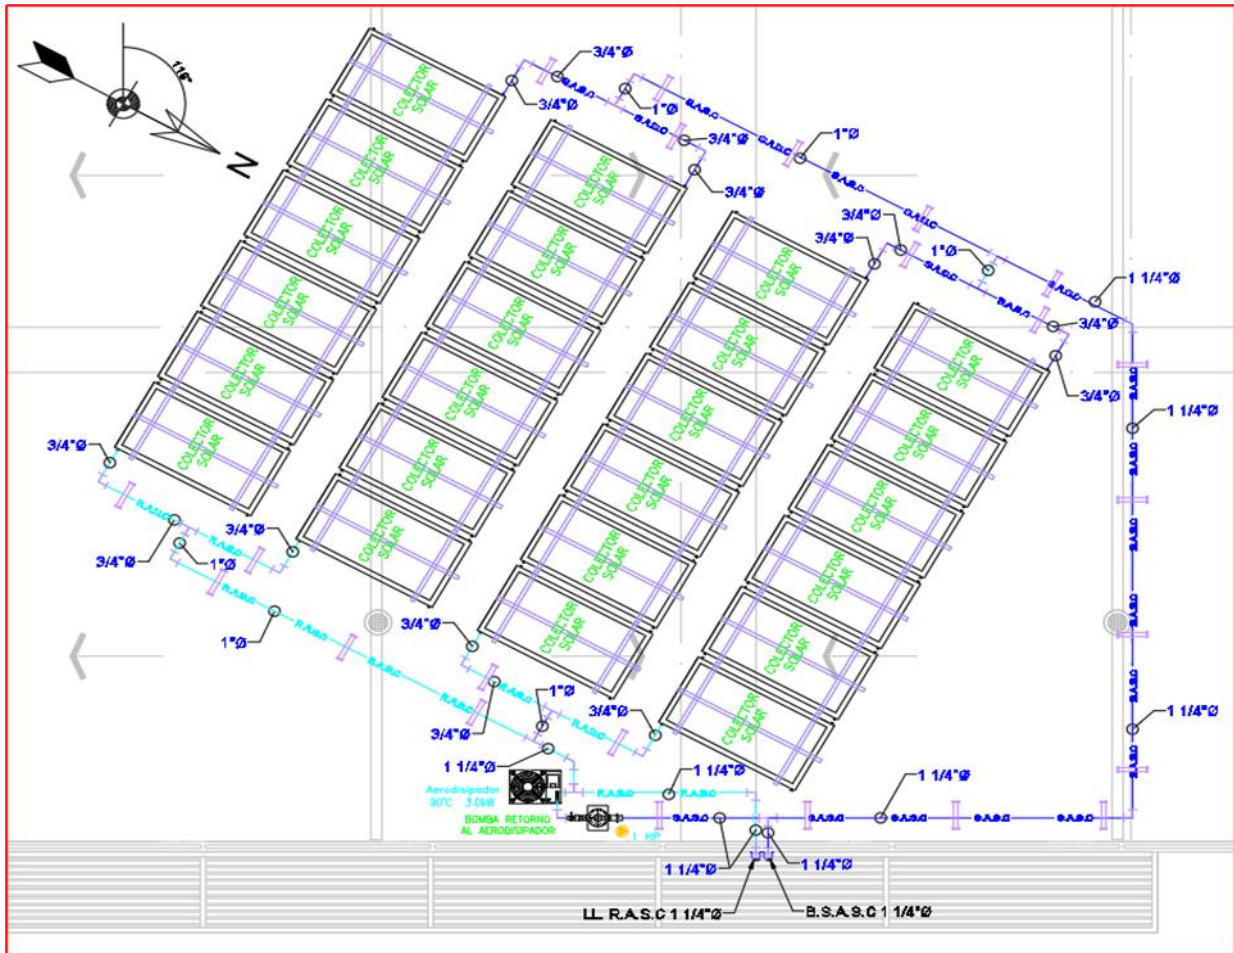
Medidas de las tuberías en el Esquema de Planta Ubicado en el Techo de la Casa de Fuerza
